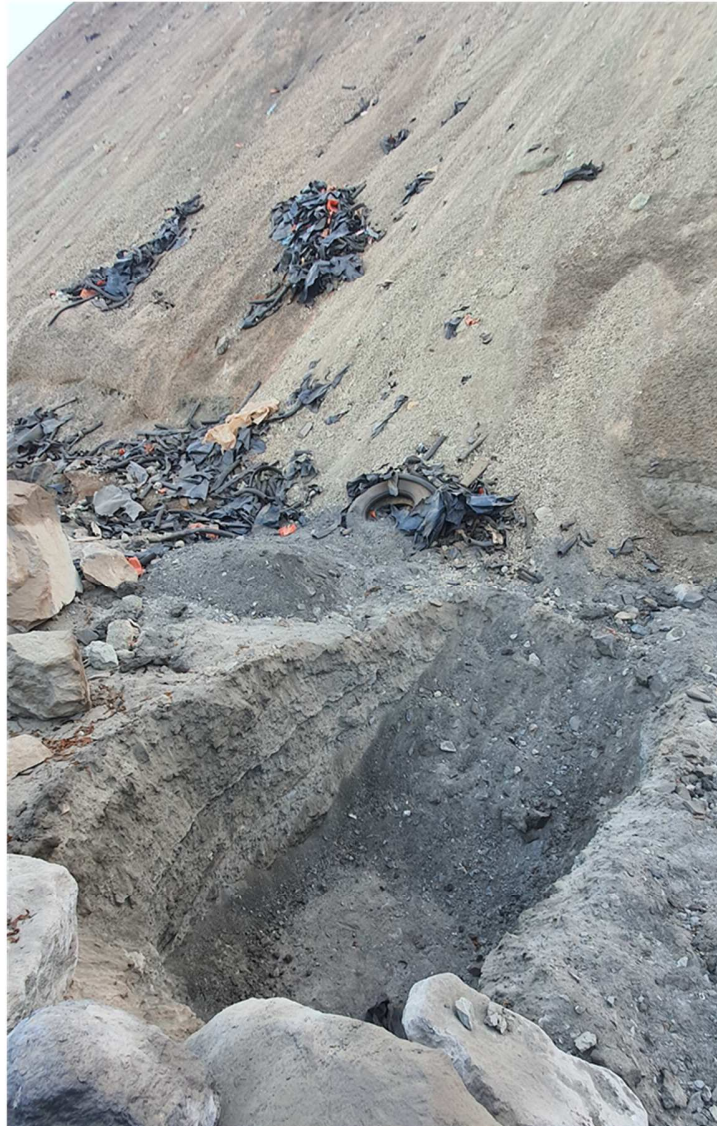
Zanja Impermeabilizada Botaderos 1 y 2
